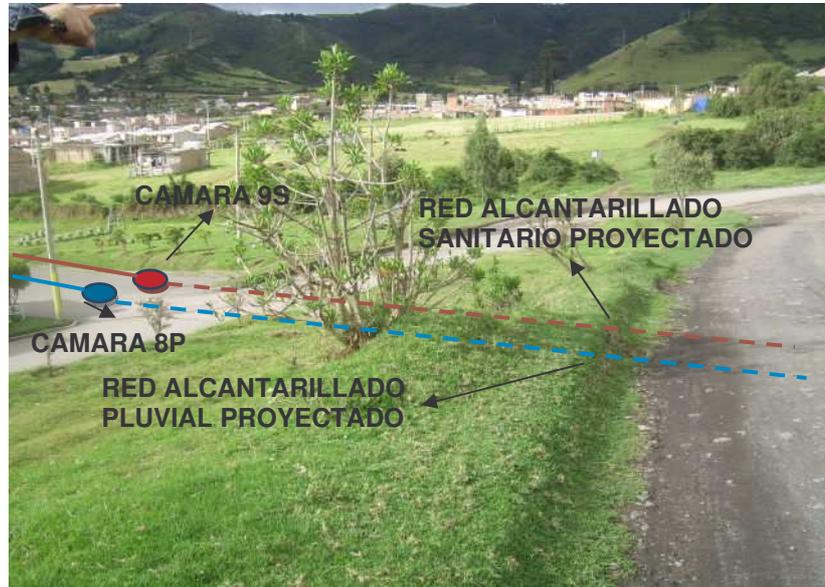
INSPECCIÓN DE CAMPO URBANIZACIÓN TORRE LADERA (EMPALME RED ALCANTARILLADO PLUVIAL Y SANITARIO SOBRE ALCANTARILLADO EXISTENTE B/ NUEVO HORIZONTE).
